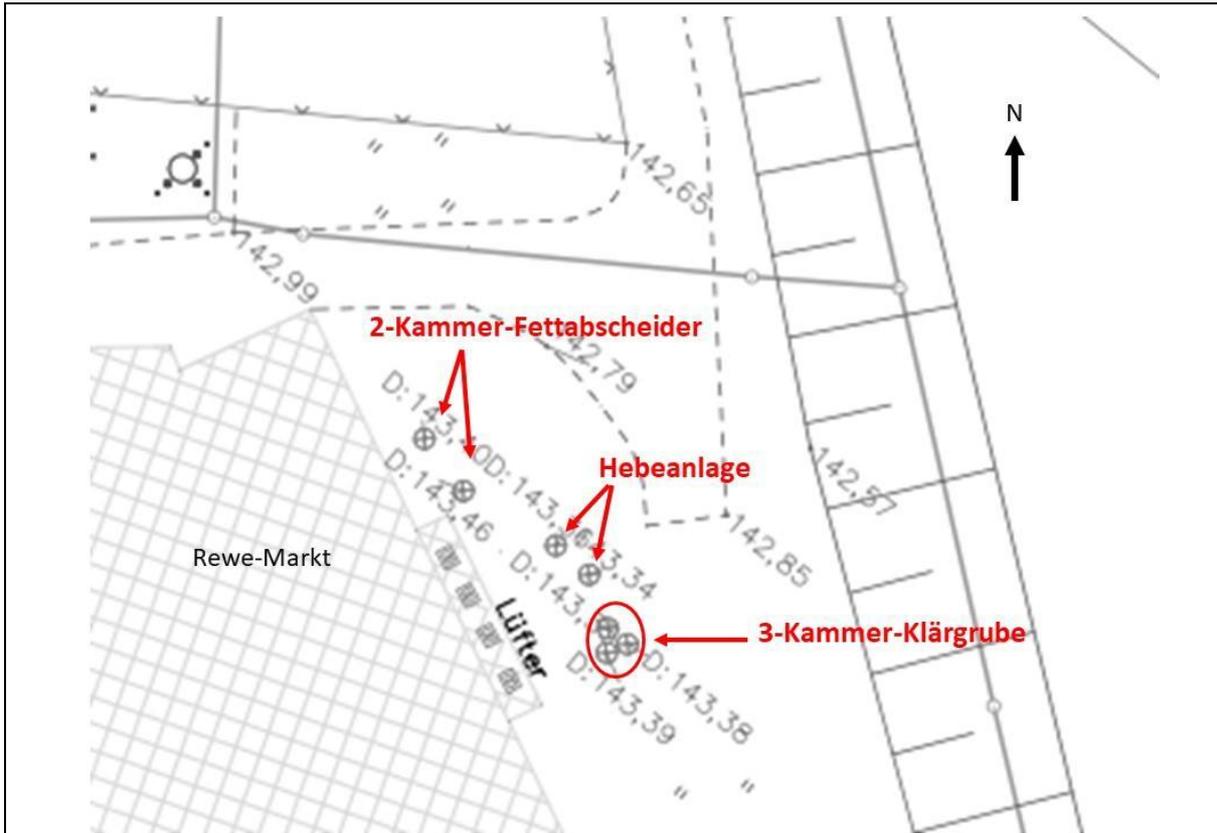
Lageplan mit vorhandenen Abwasserbeseitigungsanlagen
